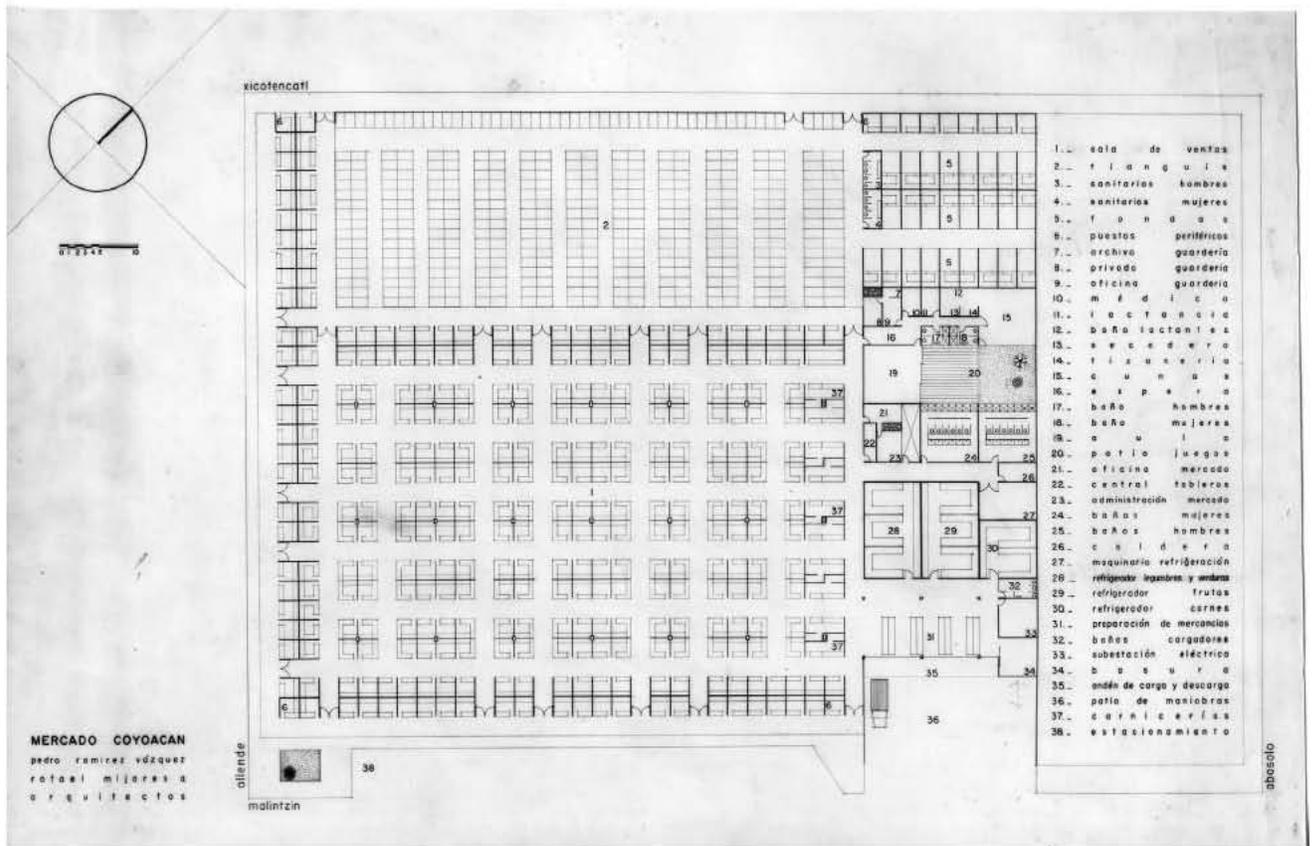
Planta arquitectónica del mercado de Coyoacán, archivo de Pedro Ramírez Vázquez, 1957.
